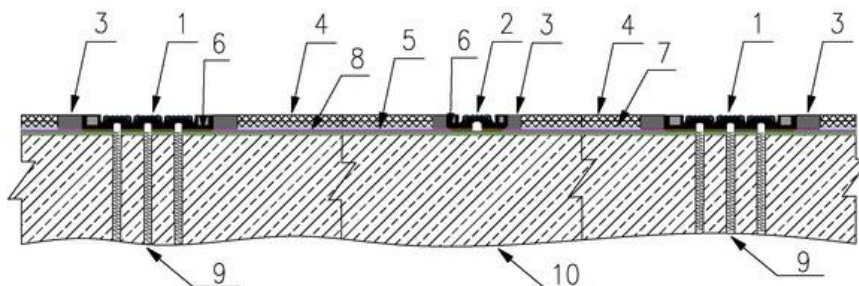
Схема элементов одежды ездового полотна транспортных железобетонных пролетных сооружений.
